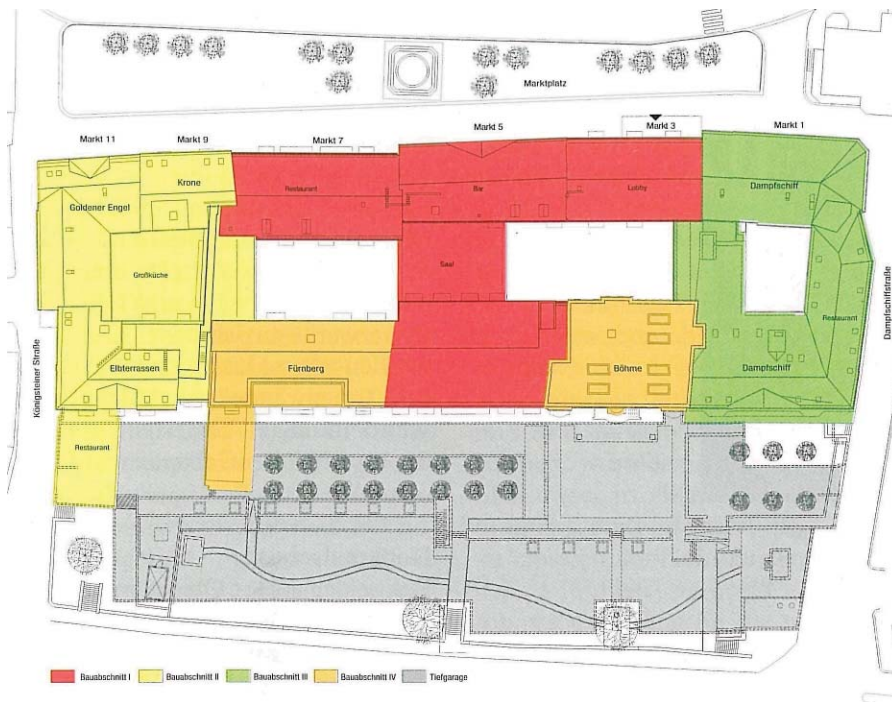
Lageplan mit Übersicht der einzelnen Bauabschnitte
